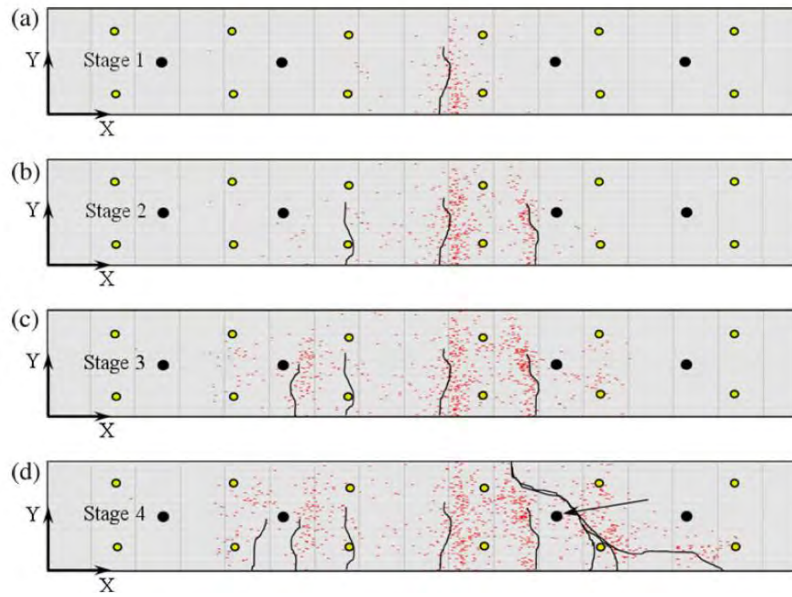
Développement des fissures dans la poutre à différents stades de l'essai [81]
